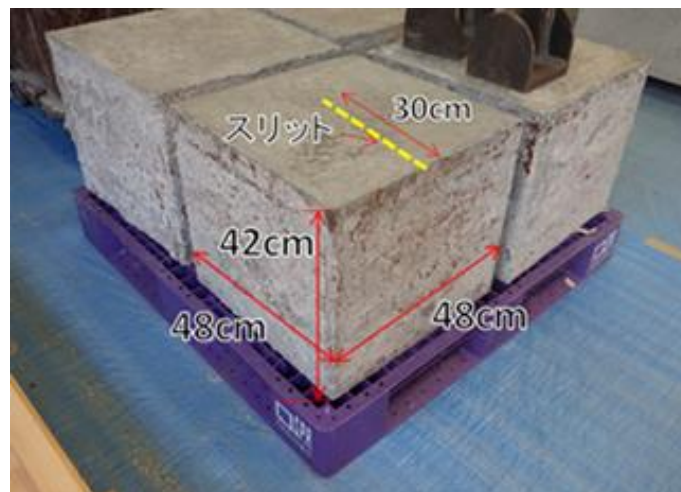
板ジャッキ工法によるひび割れ誘発試験に用いた試験体②
